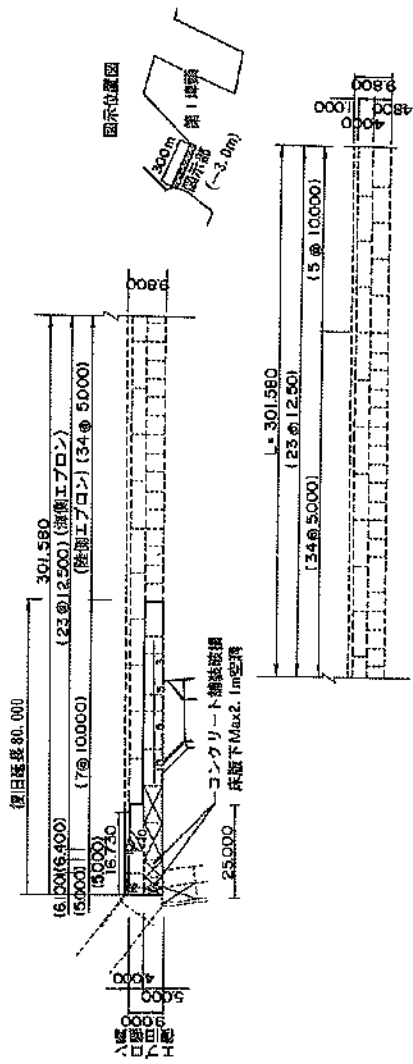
被災状況平面図・法線変位図 (第1埠頭地区, ①石油護岸)
